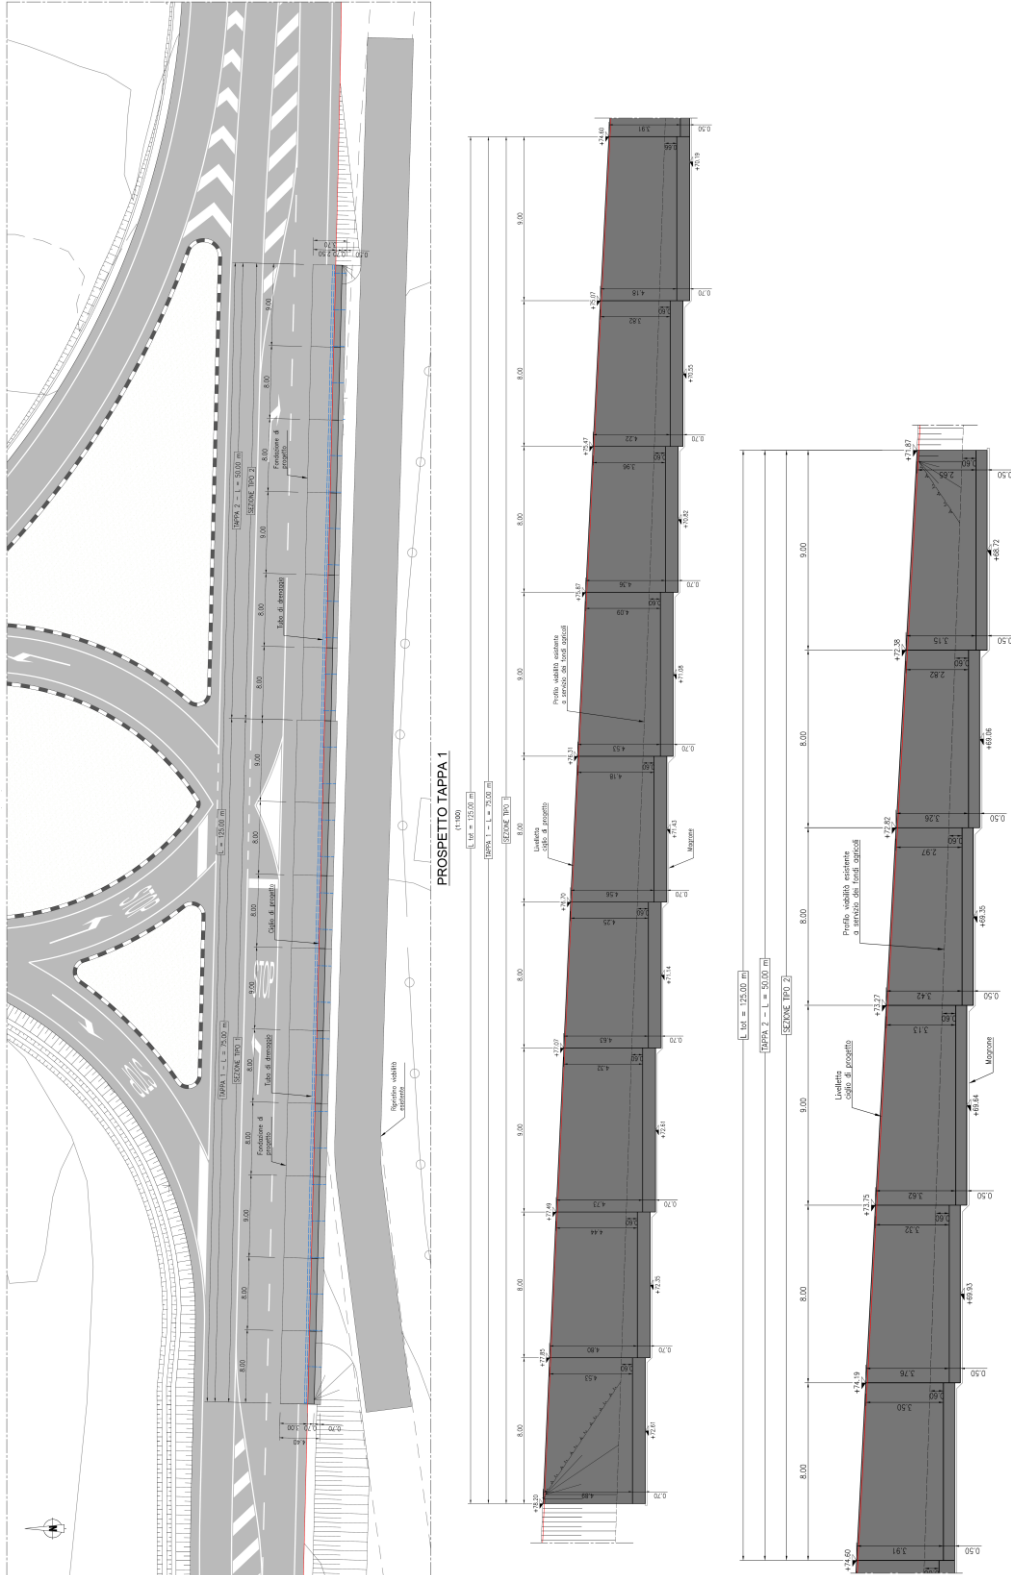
Pianta e profilo longitudinale del muro di sostegno
